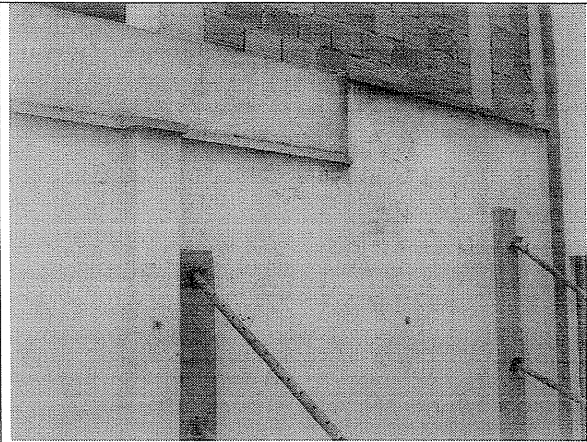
Apuntalamiento provisional del muro de lindero de la parte posterior, costado occidental.
